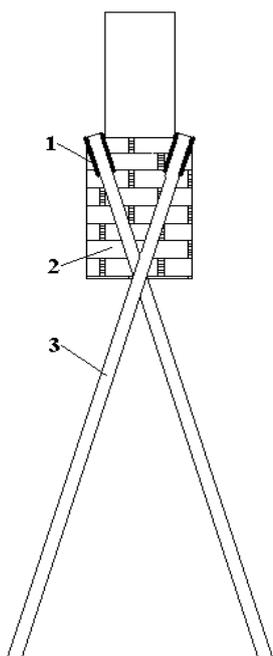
Усиление буроинъекционными сваями: 1 – труба-кондуктор; 2 – существующий фундамент; 3 – буроинъекционные сваи
